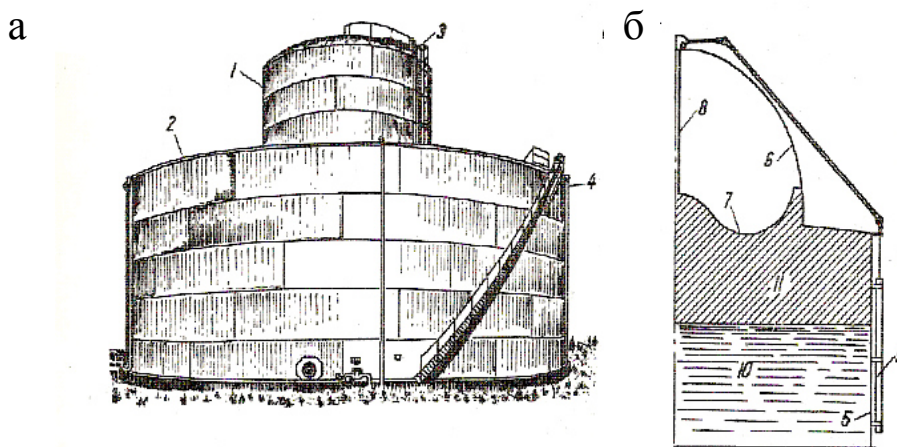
Резервуари з газокомпенсатором: а – циліндричний, б – схема куполоподібного фазокомпенсатора; 1 – циліндричний газокомпенсатор об'ємом 210 м³; 2 – резервуар місткістю 1810 м³; 3 – майданчик для обслуговування; 4 – сходи; 5 – корпус; 6 – напівсферичне покриття; 7 – гнучка мембрана; 8 – трос; 9 – показчик положення мембрани; 10 – нафтопродукт; 11 – газовий простір
